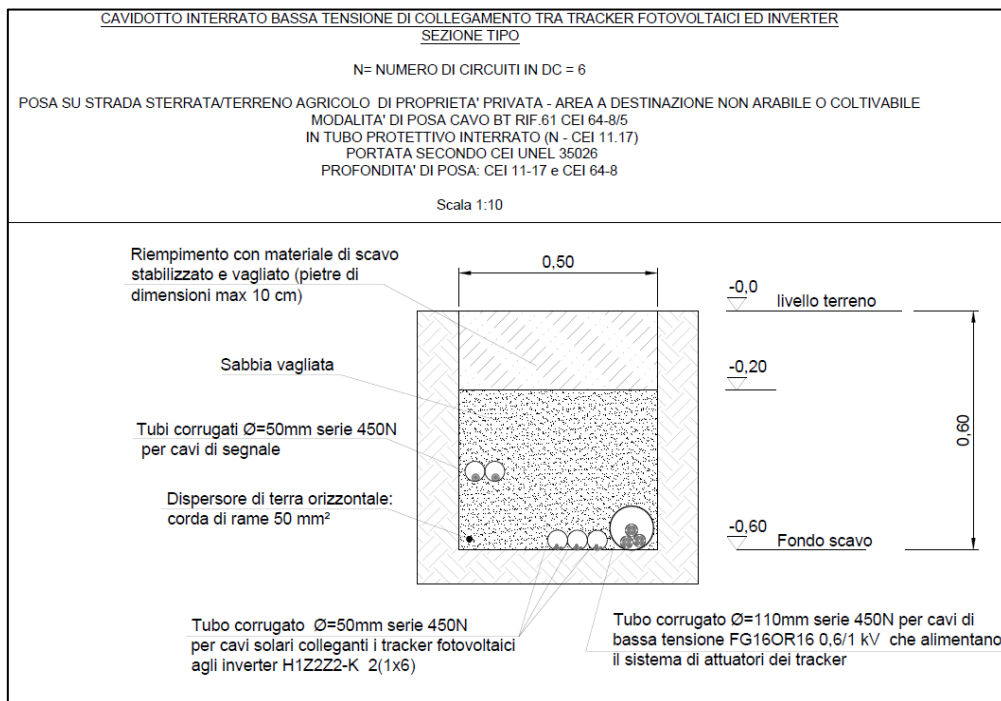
Tipologico sezione cavidotto a bassa tensione
